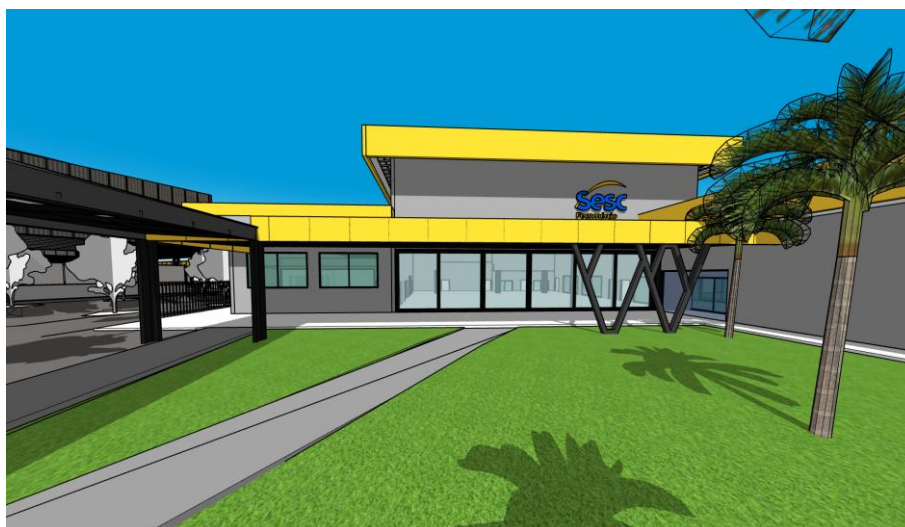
PASSARELA 05 (PASSARELA ENTRADA ITEM 5 DA PLANILHA) - de acesso a Unidade Escolar – em estrutura metálica com telha metálica e fechamento com REVESTIMENTO EM ALUMÍNIO COMPOSTO (ACM 3MM pintado com tinta automotiva amarelo Pantone 7408C, acabamento acetinado - seguir a mesma cor da platibanda existente). Pilares pintado na cor preto fosco.
